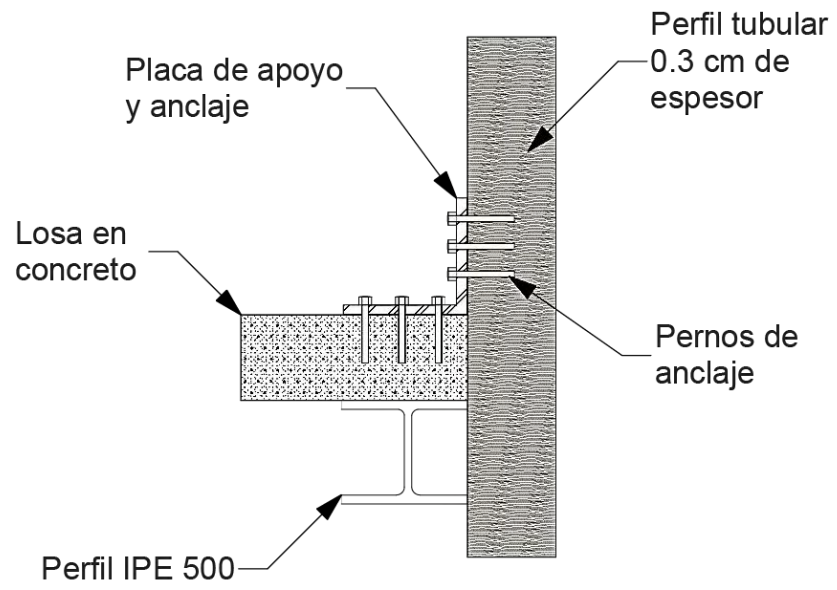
Detalle sección fachada auditorio Música. Fuente: Elaboración Propia.
